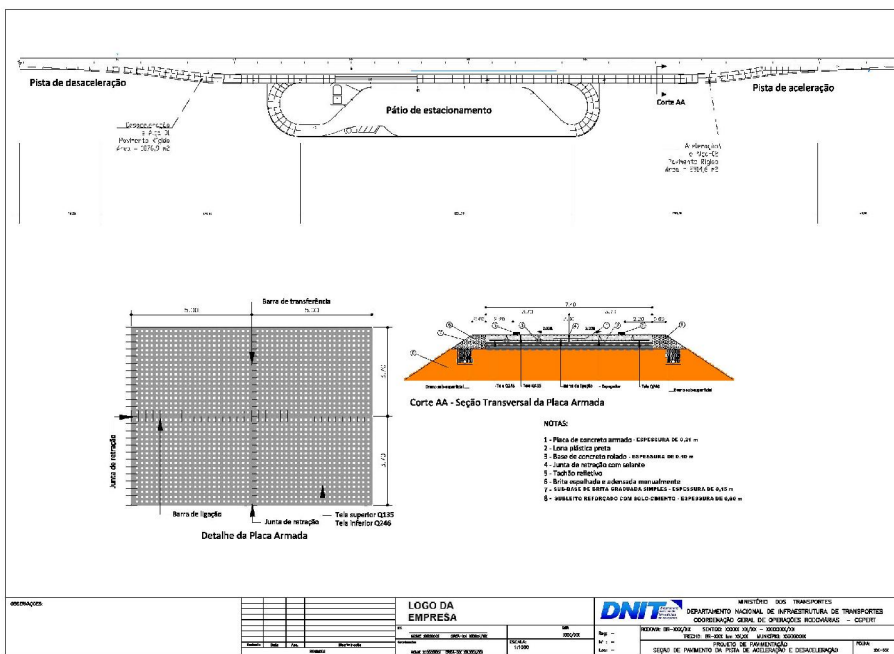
Detalhe da seção tipo da pavimentação e da solução para as pistas de aceleração e desaceleração.
